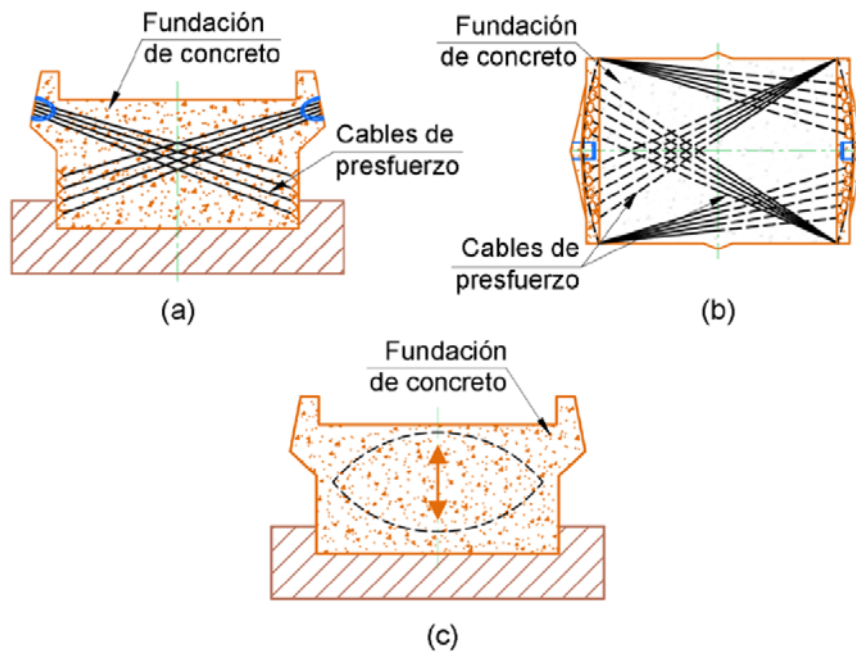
Concreto presfuerzo (a) alzado con disposición de cables (b) planta con disposición de cables (c) esfuerzos internos de compresión resultantes en la fundación
